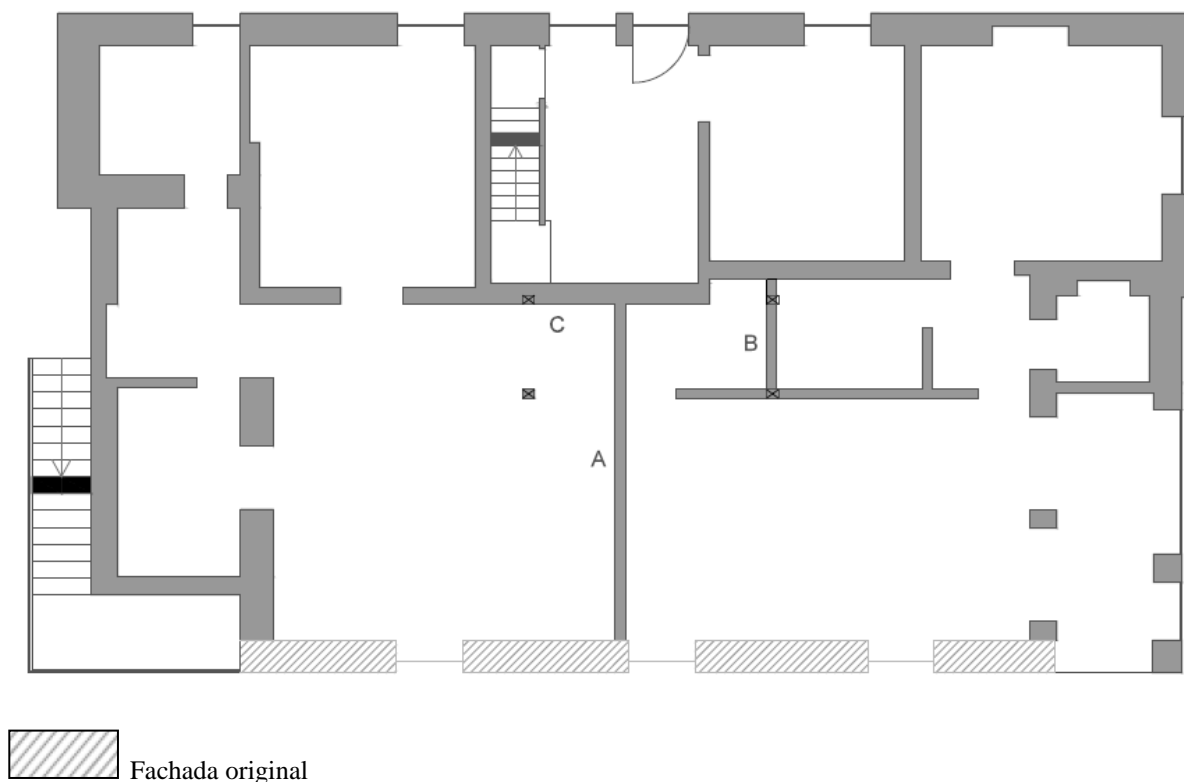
Planta atual com alteração da fachada lateral esquerda pela original. Piso térreo
